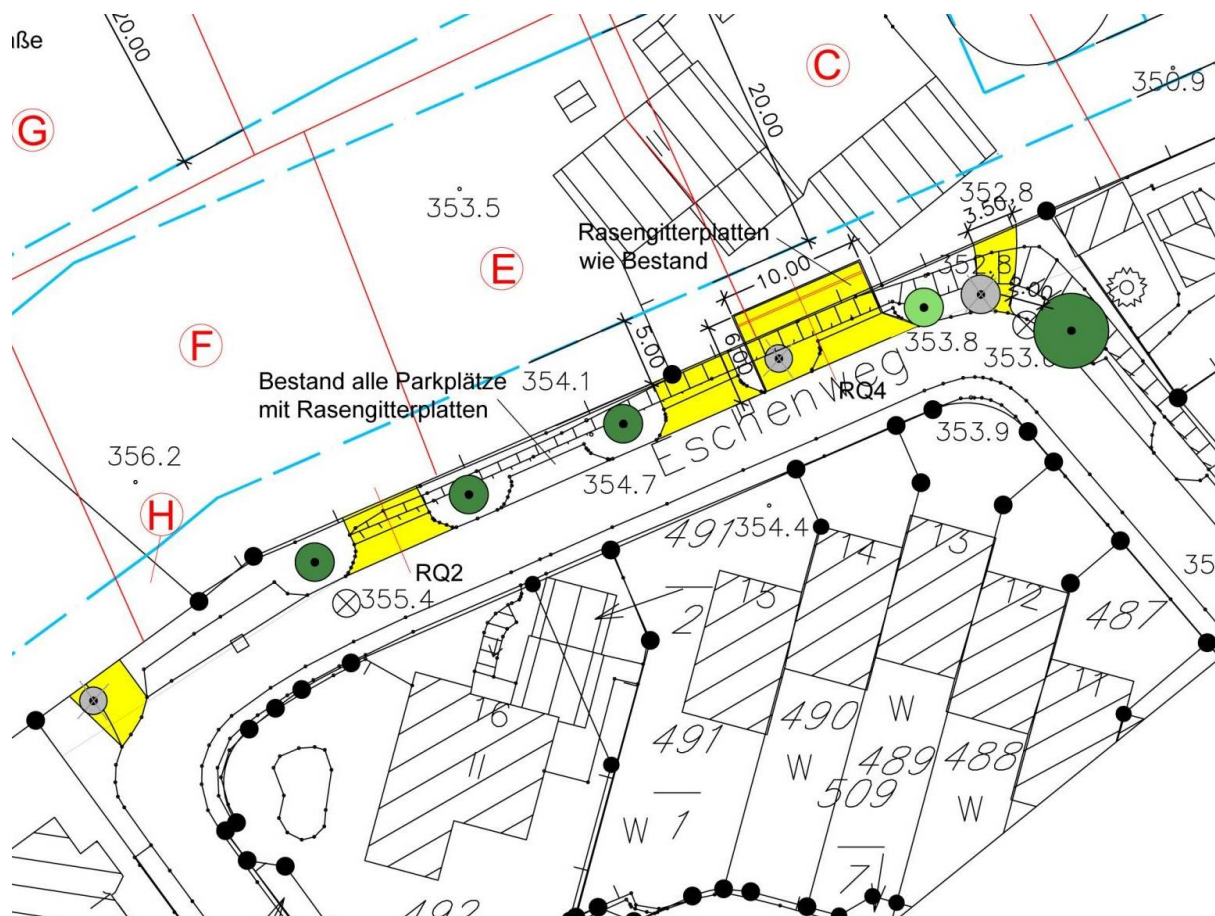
Umgestaltung der Parktaschen und Einordnung der Zufahrten zu den Grundstücken am Eschenweg, Planausschnitt aus Anlage 2 zum Erschließungsvertrag
